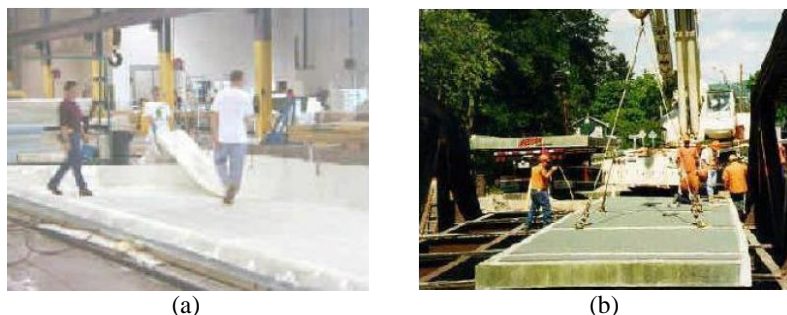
Fabricação (a) e instalação do tabuleiro da ponte *Chemung Country Bridge*.
